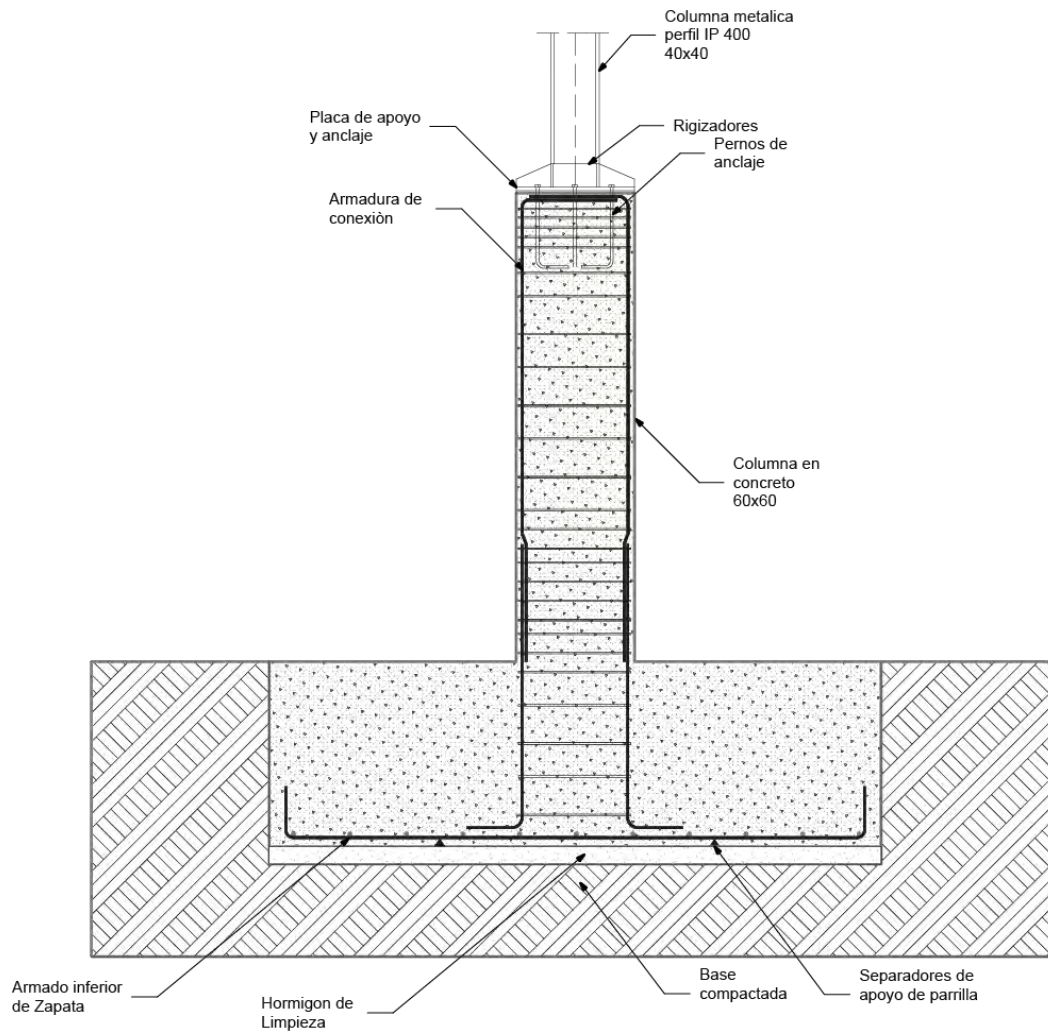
Detalle sección columna primer piso Bloque A (Hospedaje). Fuente: Elaboración Propia.
